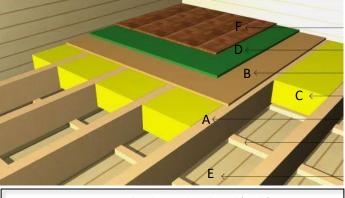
plancher en bois lamellé collé. Source : www.googleimages.com
